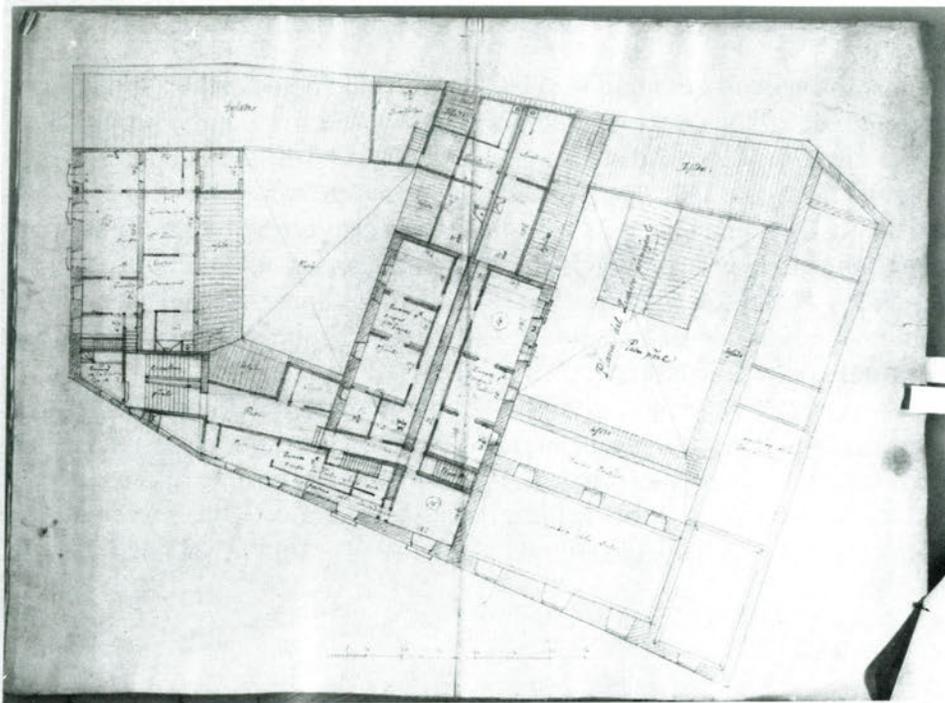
Casa de Rebeque, 1750. Planta principal. (A.P.)
